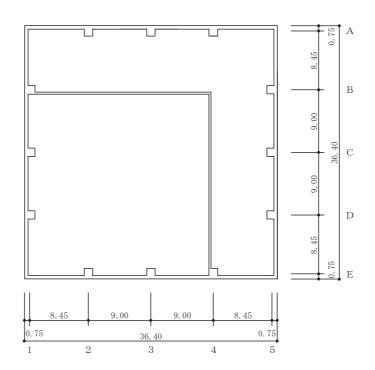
(2) 緊急時対策建屋の概略平面図 (0.P.57.3m)
